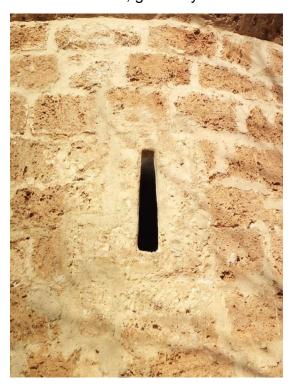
Ermita de San Pedro. Ventana al sur del ábside y detalle en piedra de toba. (Fotografía de la autora)
